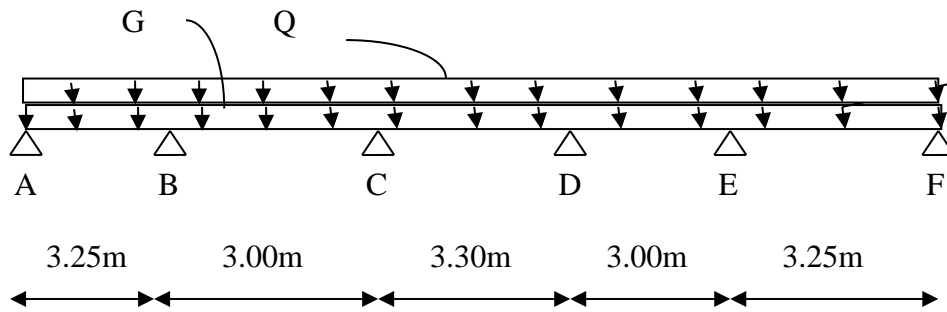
Schéma statique de la poutre continue reposant sur 06.
